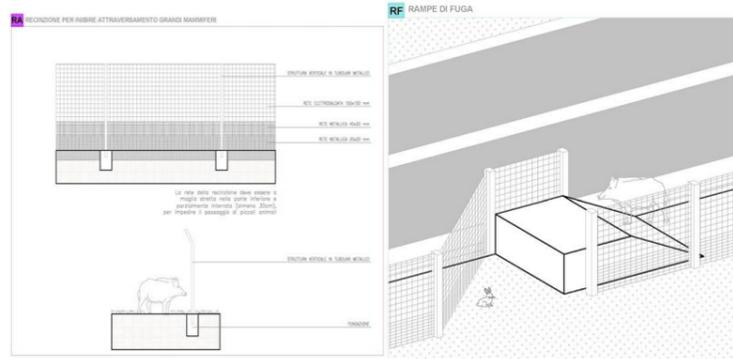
Assonometria schematica, prospetto e sezione della recinzione e delle rampe di fuga
